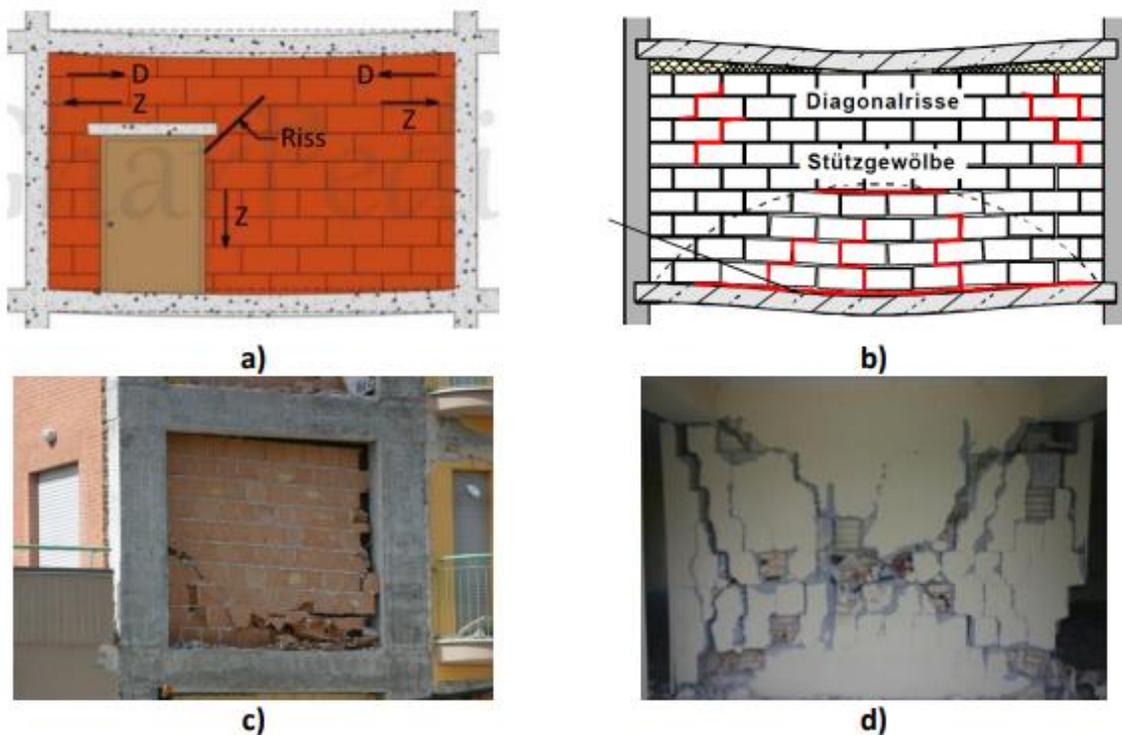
Risse durch Formänderungen: a) Ausfachung mit Öffnung, b) nichttragende Trennwand, Erdbebenschäden: c) Ausfachung, d) nicht tragende Trennwand.
